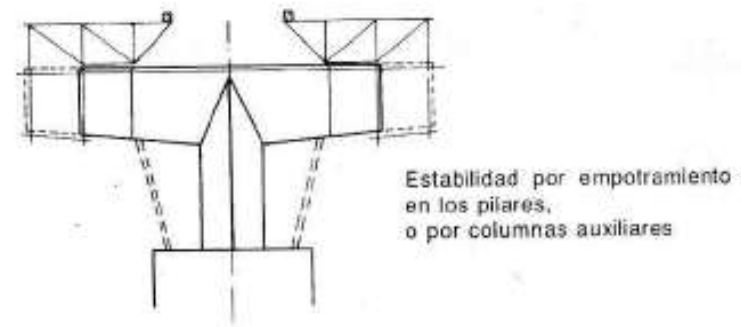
Construcción por voladizos sucesivos con cimbras móviles + encofrados = módulo de encofrado.
